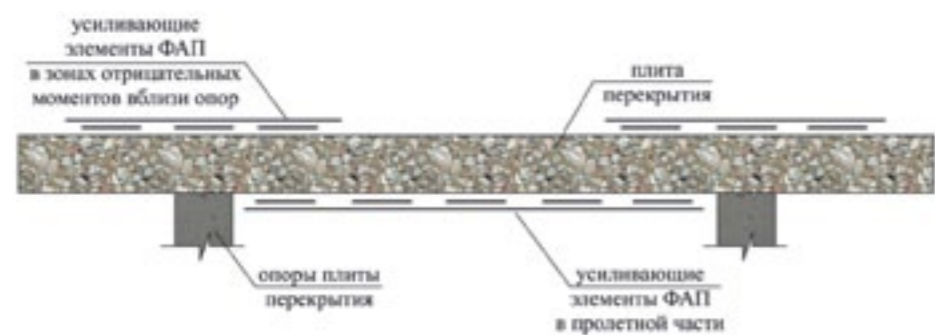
Усиление плиты перекрытия внешним армированием ФАП
